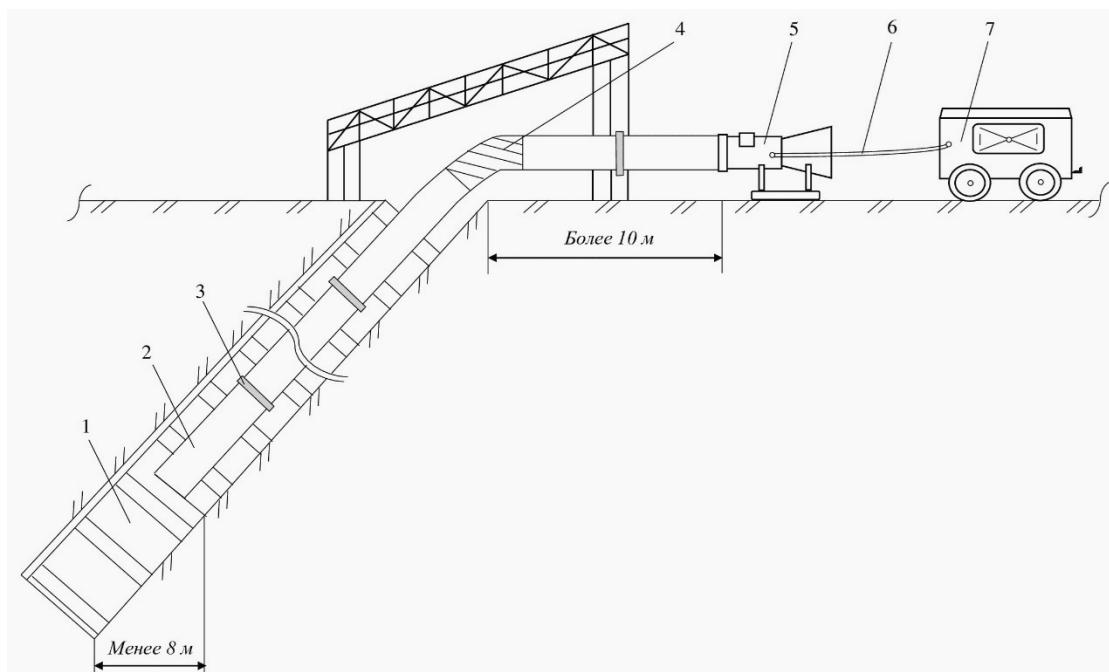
Схема компоновки технических средств проветривания малых угледобывающих предприятий при ведении горноспасательных работ: 1 – горная выработка; 2 – вентиляционный трубопровод; 3 – соединение отрезков вентиляционного трубопровода; 4 – металлическое соединительное колено; 5 – пневматический или электрический ВМП; 6 – рукав для подачи сжатого воздуха или электрический кабель; 7 – источник пневматической или электрической энергии
